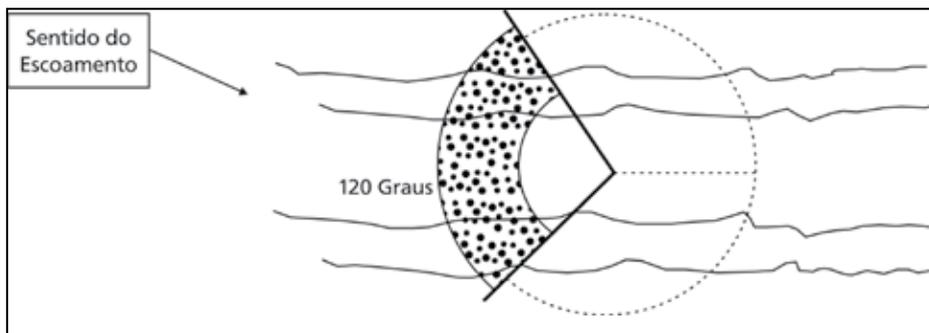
Planta Baixa de uma Barragem Sucessiva de Pedra
